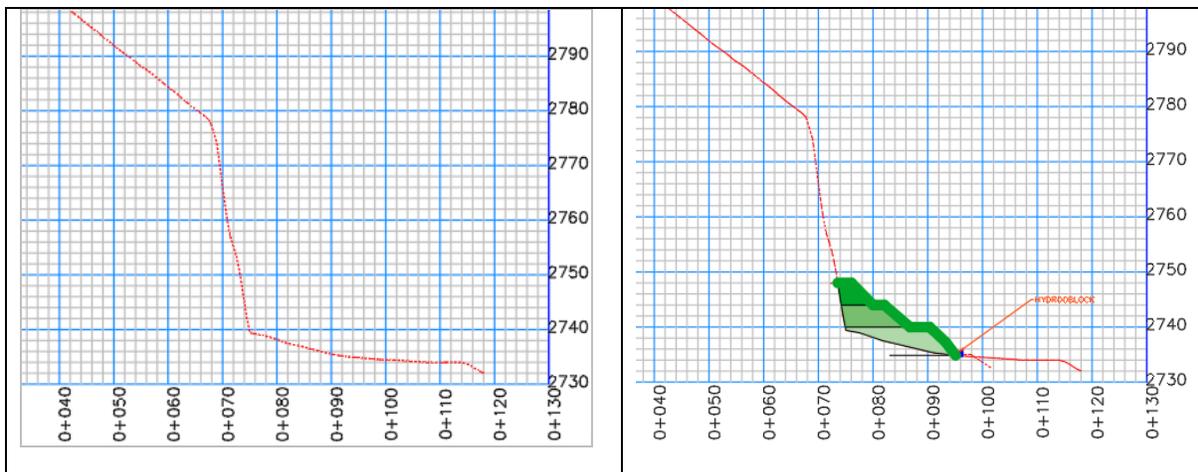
Sección Tipo de la Zona (Izquierda) – Sección de la terraza en la zona 2 con la construcción de terrazas
